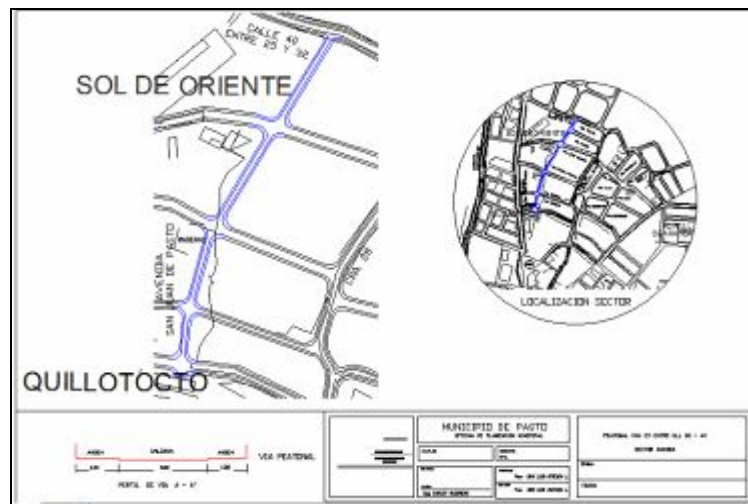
Planta y sección transversal carrera 29 entre calle 35 y calle 40
